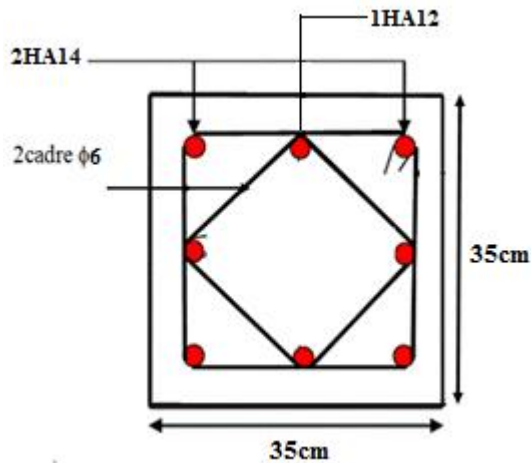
Schéma de ferrailage des poteaux *T.Cage*.
